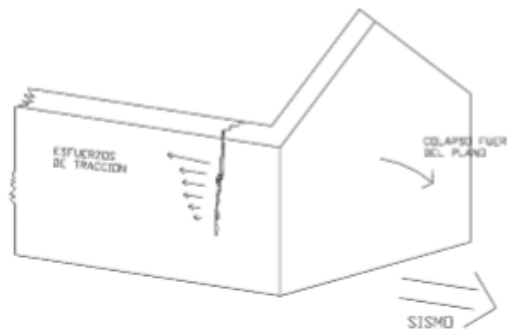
Vista en perspectiva de la falla fuera de plano. Fuente: Romero & Zhindón, 2017.
